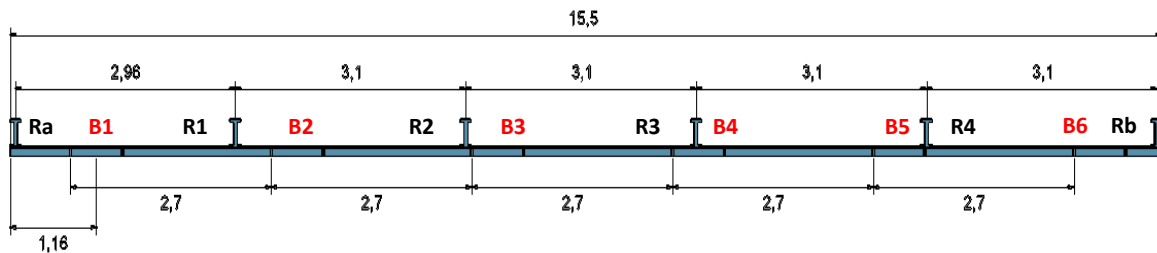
Dimensiones de la viga principal y posiciones de las cargas y reacciones proveniente de las bobinas (vista de planta)
